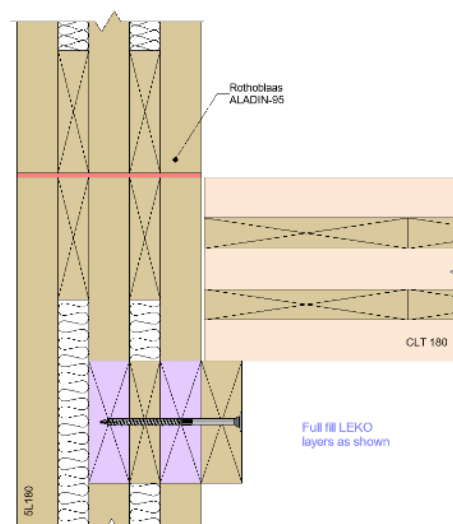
Exemple de connexion entre mur LEKO LABS et plancher CLT à l'aide d'une muralière (des fourrures sont ajoutées pour permettre le vissage et la reprise des efforts)
